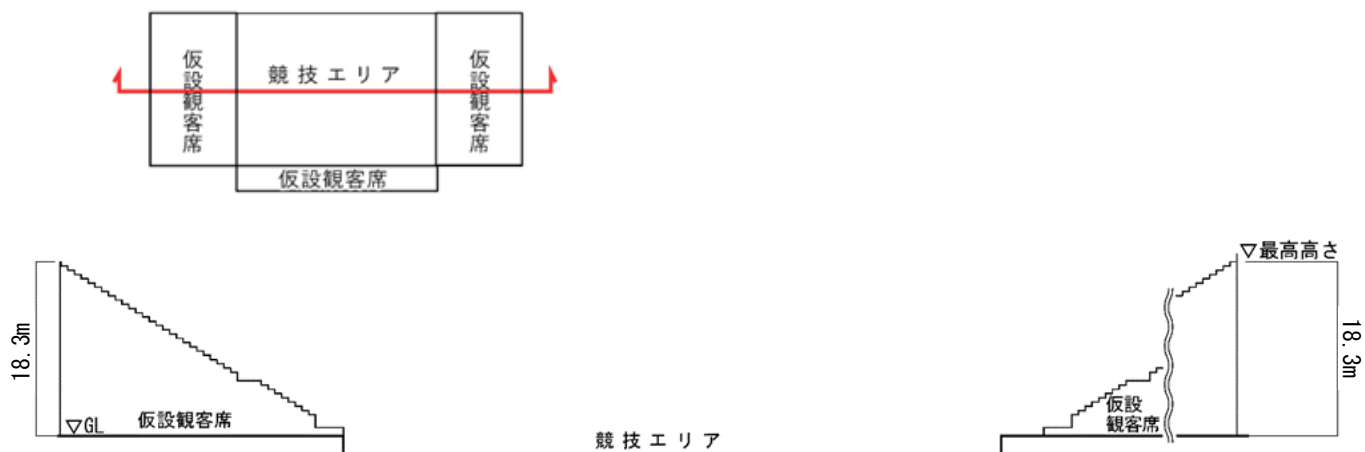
(3) 断面図 (スケートボード (パーク、ストリート))
